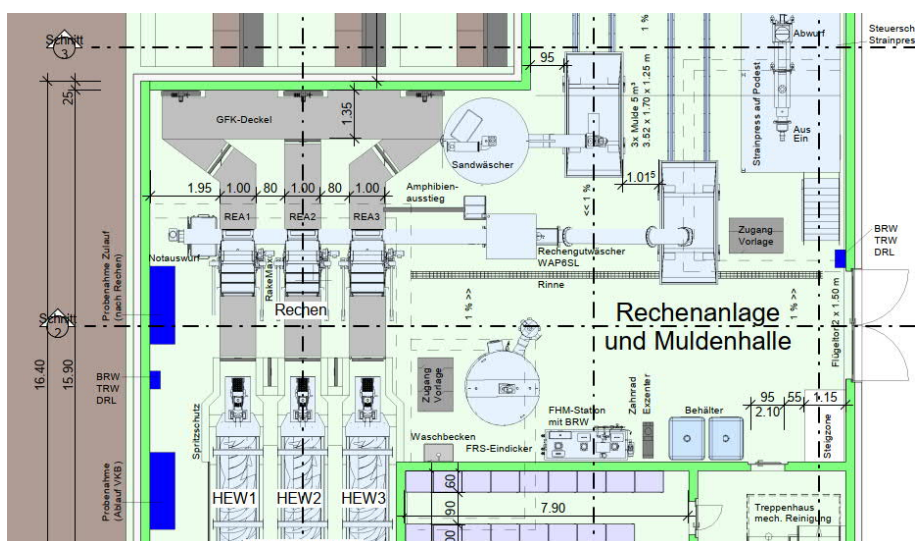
Planausschnitt; Grundriss Hebewerk / Rechenanlage
